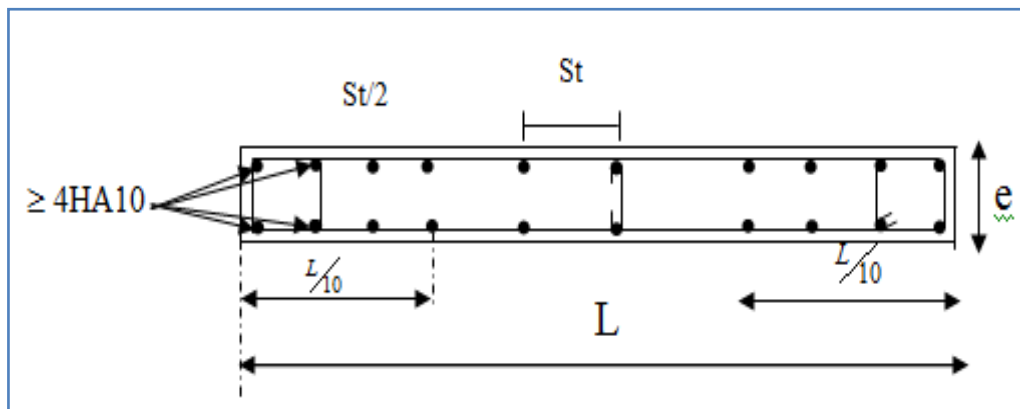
Disposition des armatures verticales dans les voiles
